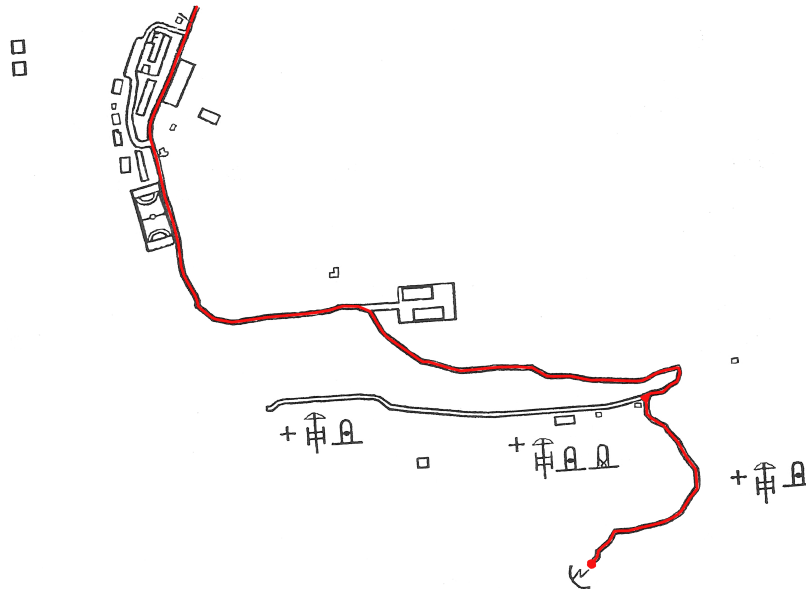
Tramo de pista afectado por las obras proyectadas.
